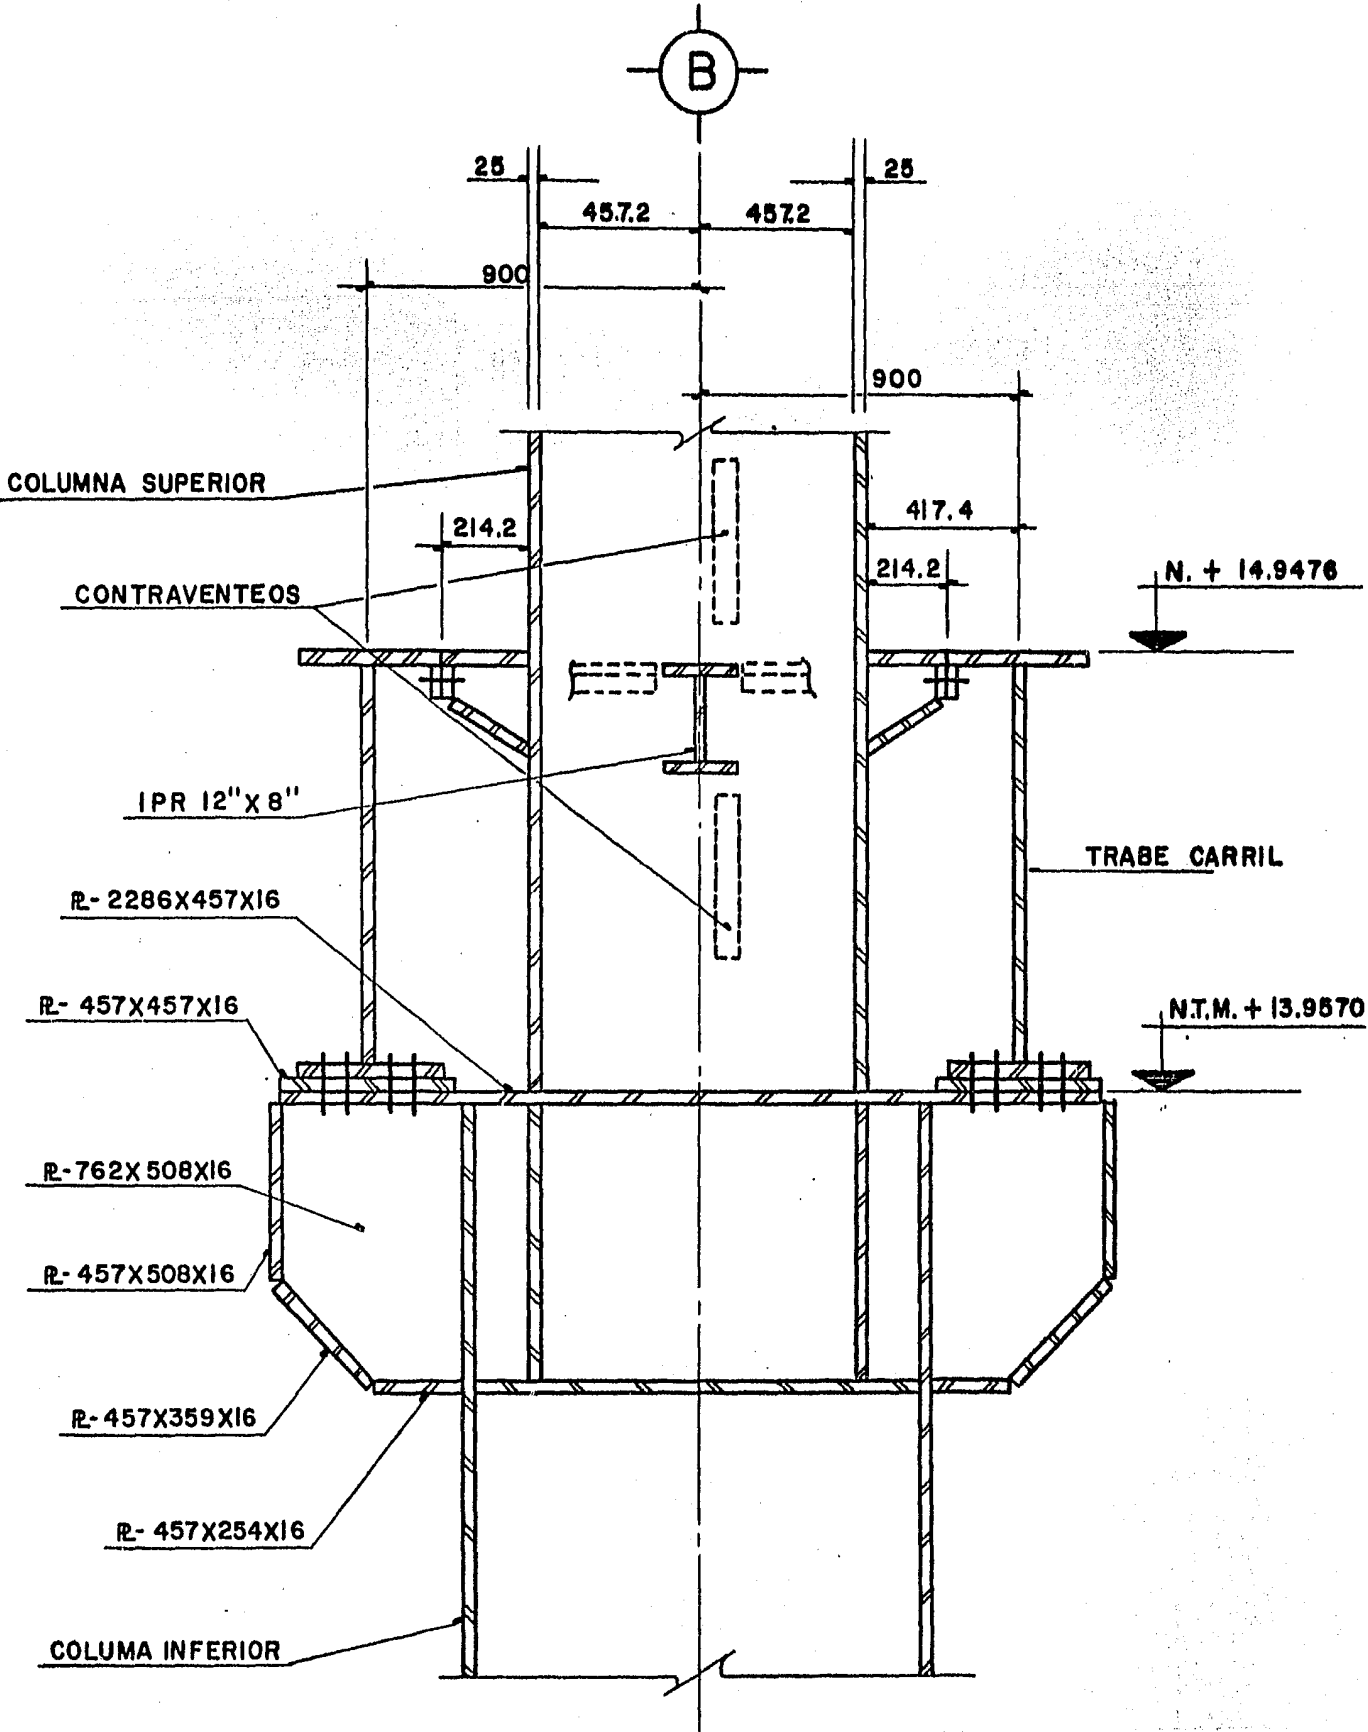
COLUMNA CENTRAL. EJE "B"
